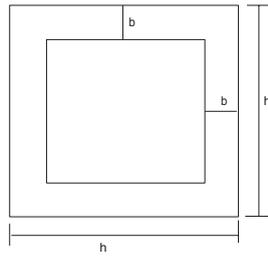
Perfil de la sección transversal en base a ángulos de acero
